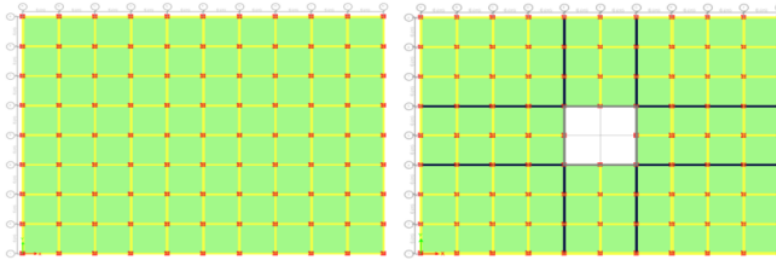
Vista en planta del modelo sin outriggers y con outriggers (Sukesh et al., 2017, p.1750)
